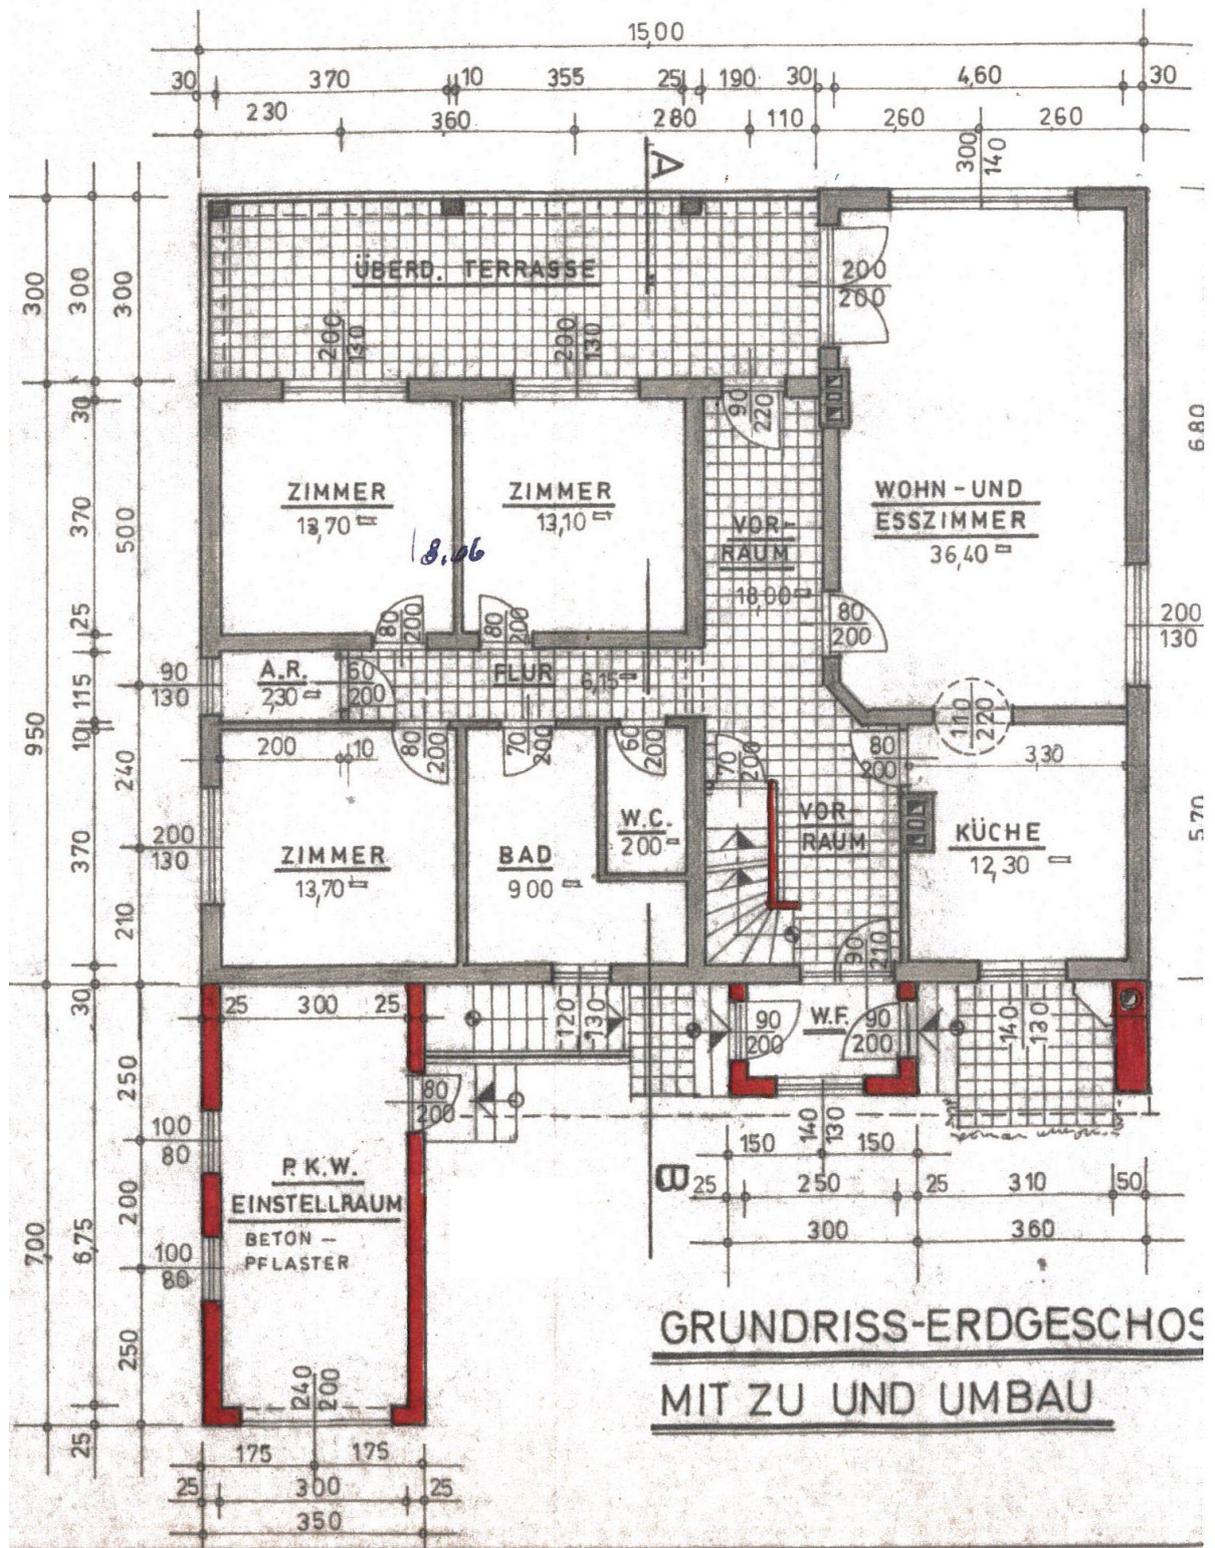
Grundriss EG – Zubauten nicht ausgeführt
